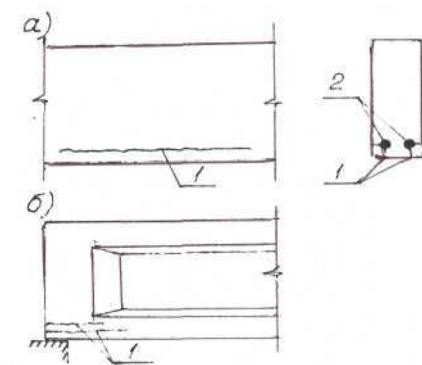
(1 — продольные трещины, 2 — арматура)
